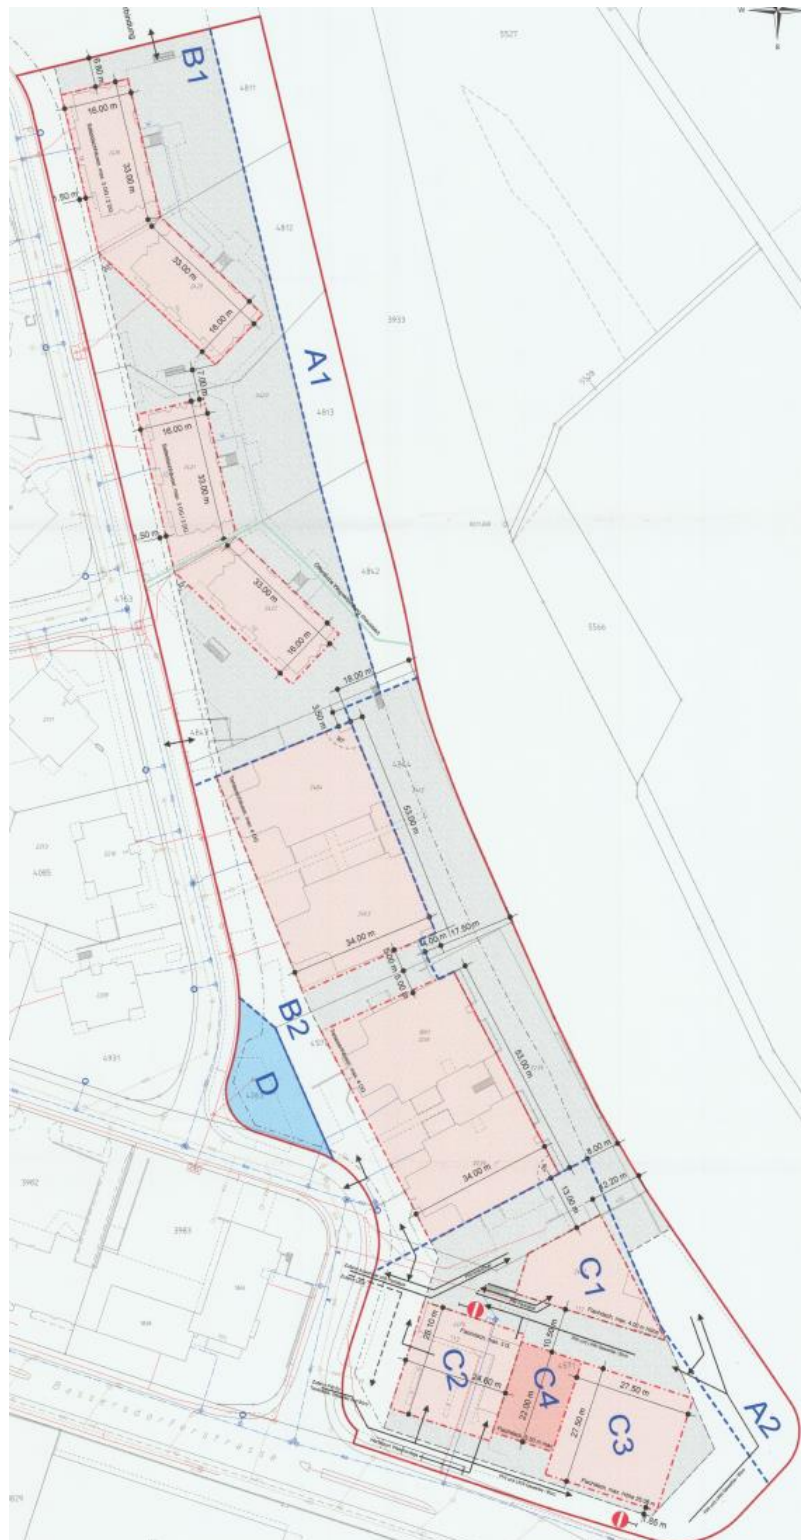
Ausschnitt öffentlicher Gestaltungsplan Gwärfihölzli, vom 20. Dezember 2001
